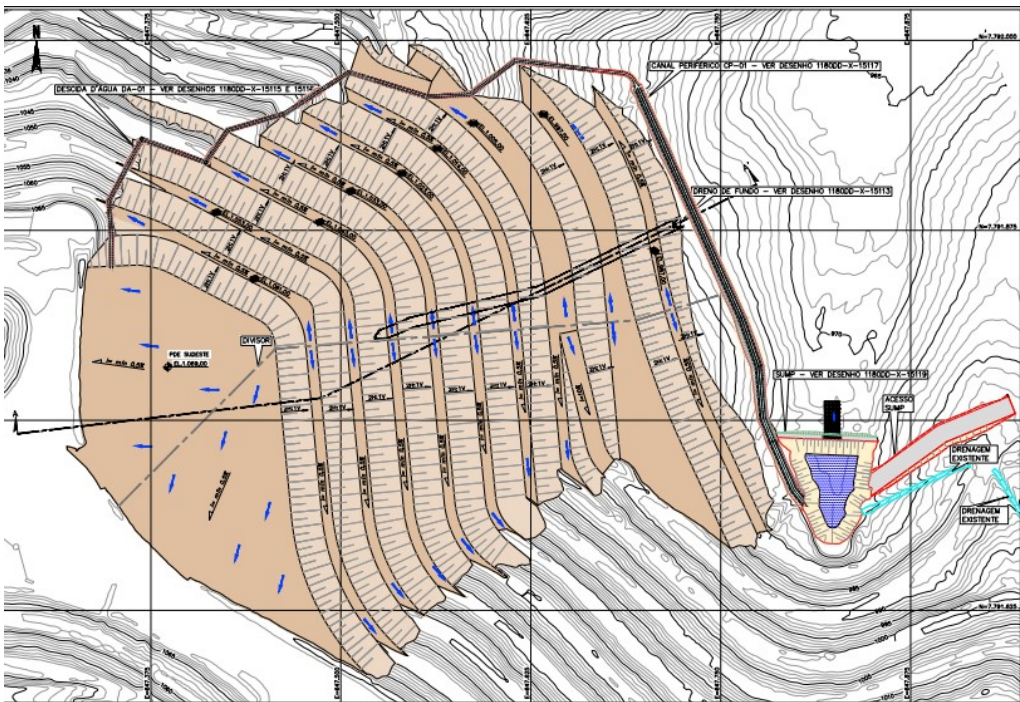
Arranjo Geral do Contrapilamento PDE Sudeste (1180DD-X-15109)
